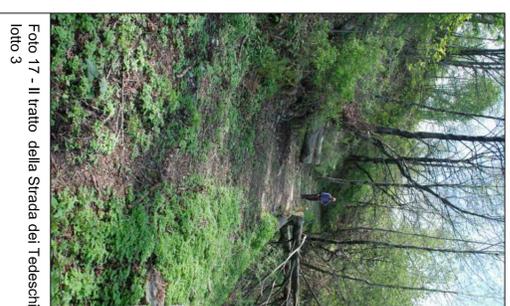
Il tratto della Strada dei Tedeschi lotto 3
